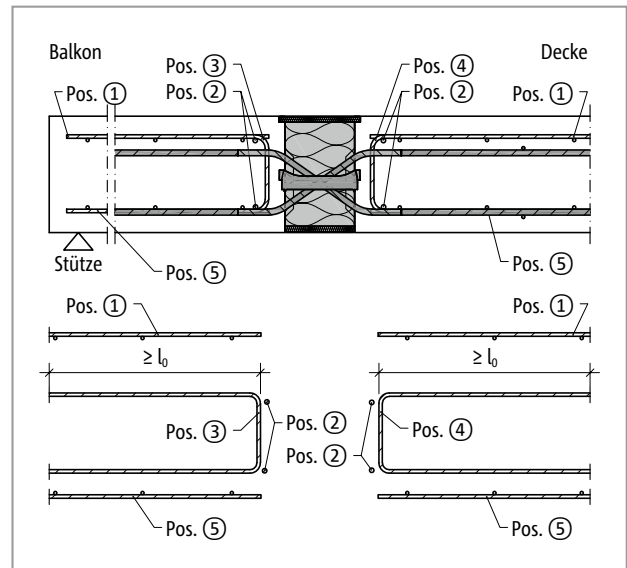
Schöck Isokorb® XT Typ Q-VV5 bis VV11 Bauseitige Bewehrung
